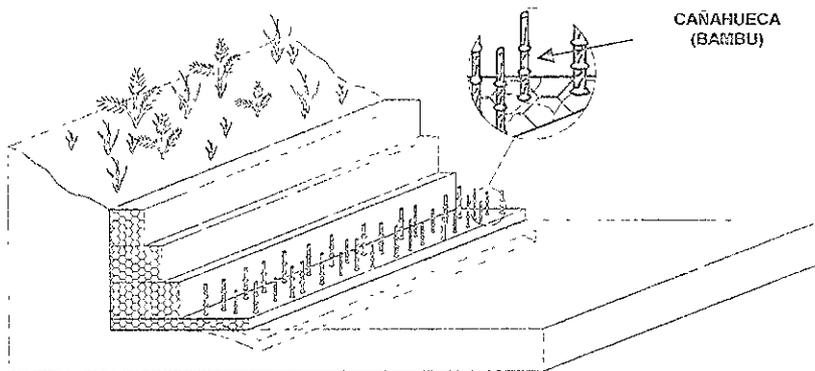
Protección del gavión con siembra de plantas típicas.
